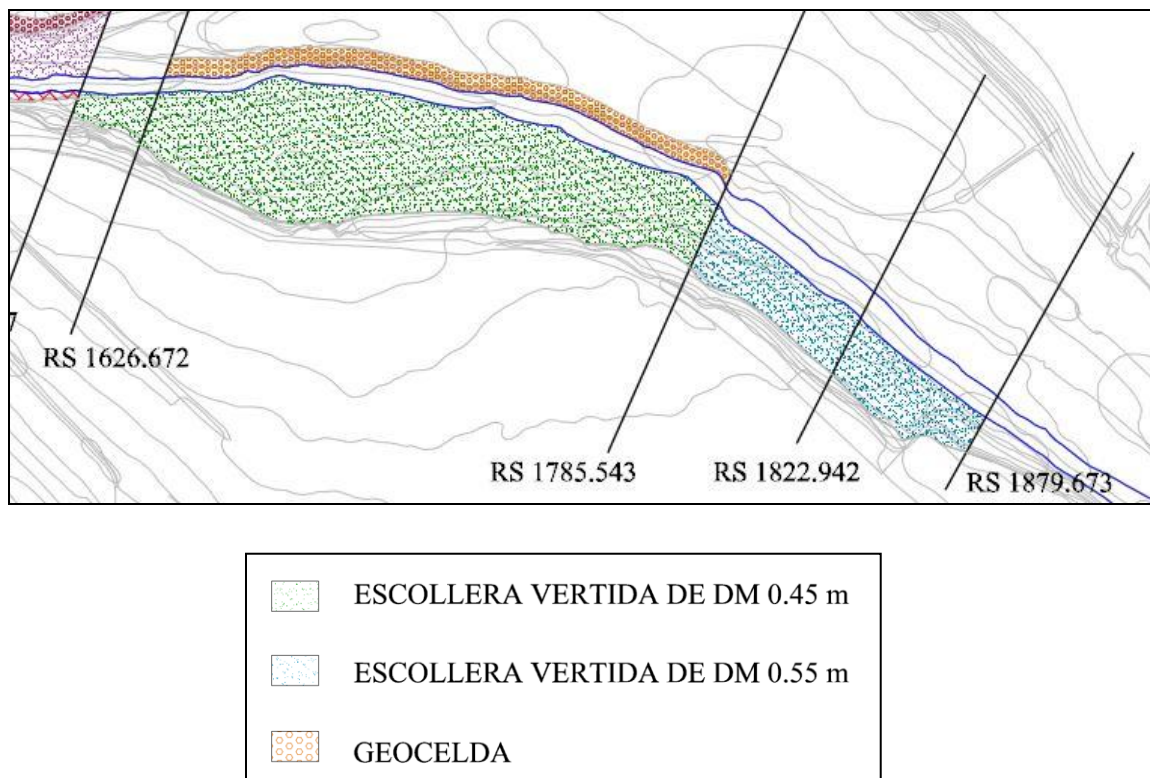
Planta de las actuaciones propuesta para el subtramo 2
